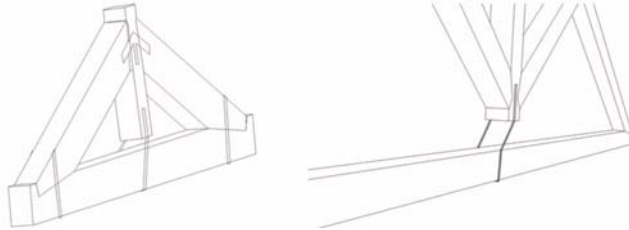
Schadenstyp P15: Schäden an Dachelementen
